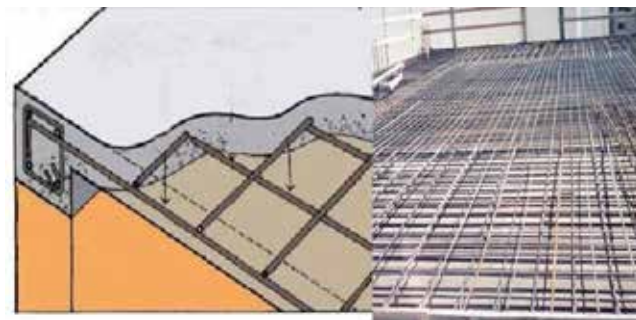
Losas macizas. Fuente: <https://www.google.com/imgres?imgurl>
